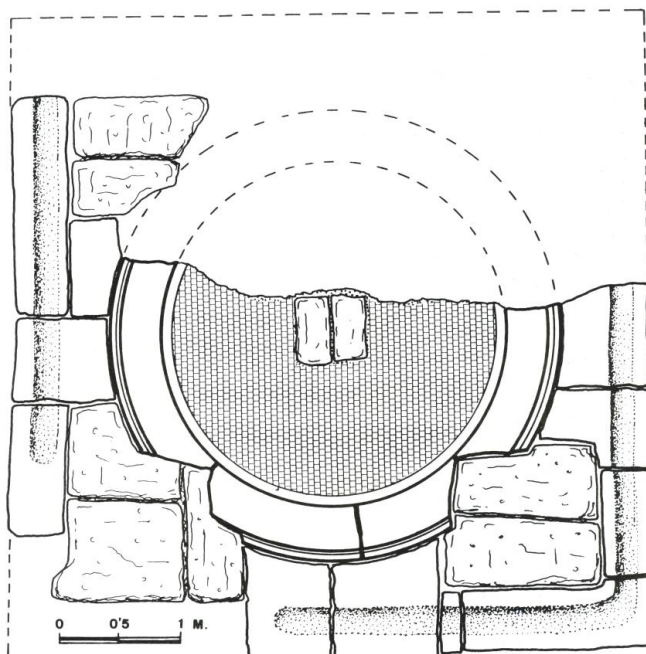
C. Saravia 1: planta de la *tholos* (VENTURA, 1996a, fig. 98).
